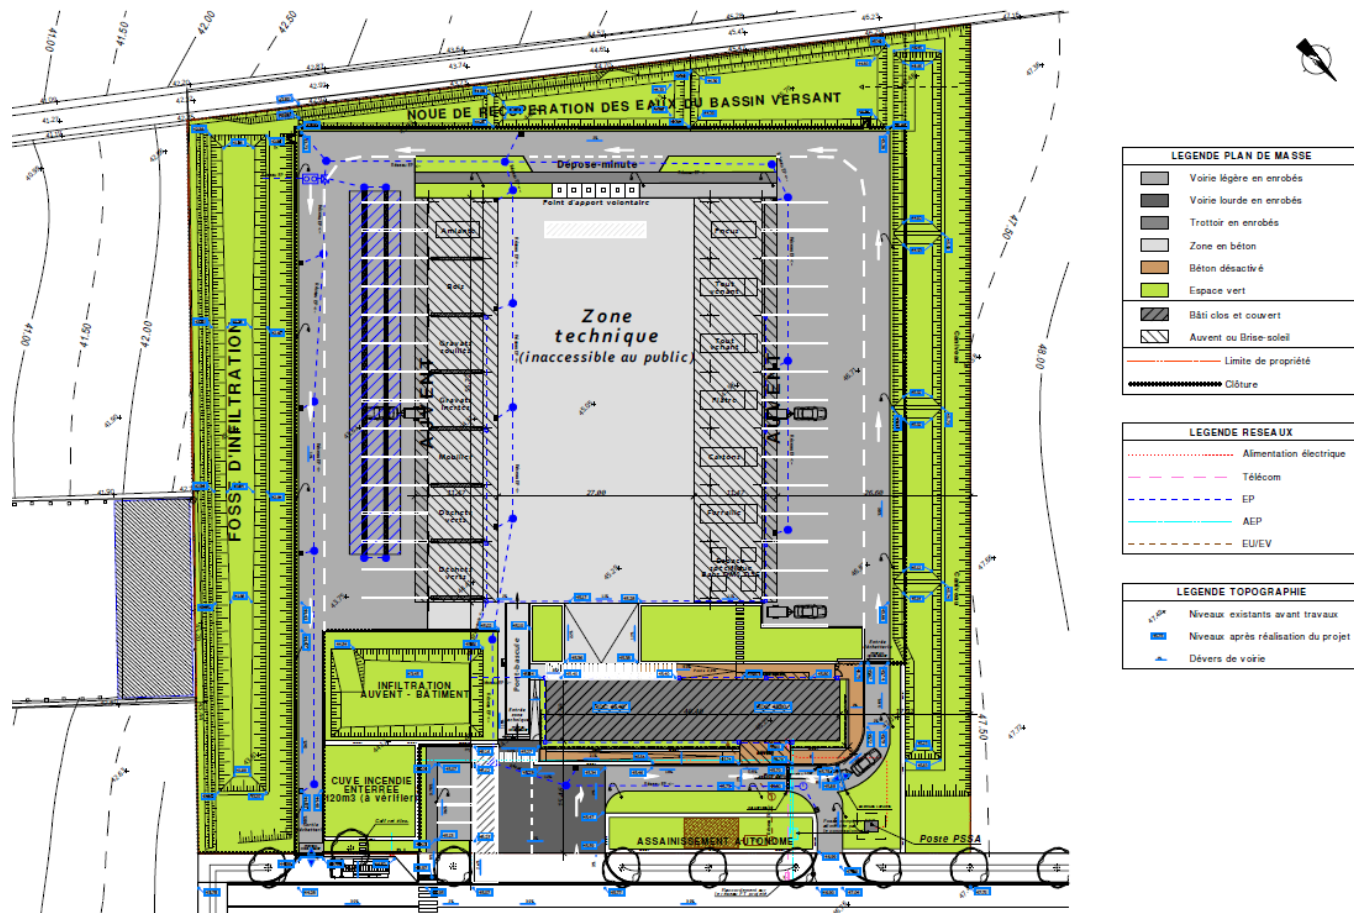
Plan de masse de la 4e déchetterie à Amiens
